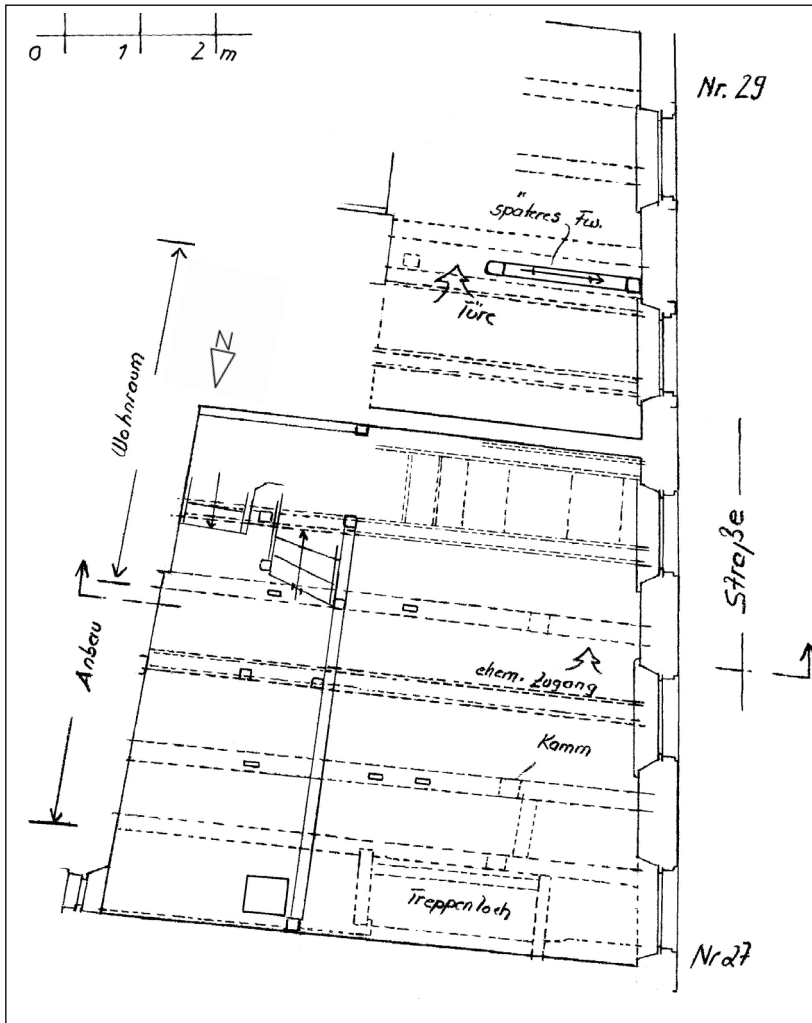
Im Grün 27, Grundriss 1. Obergeschoss.
